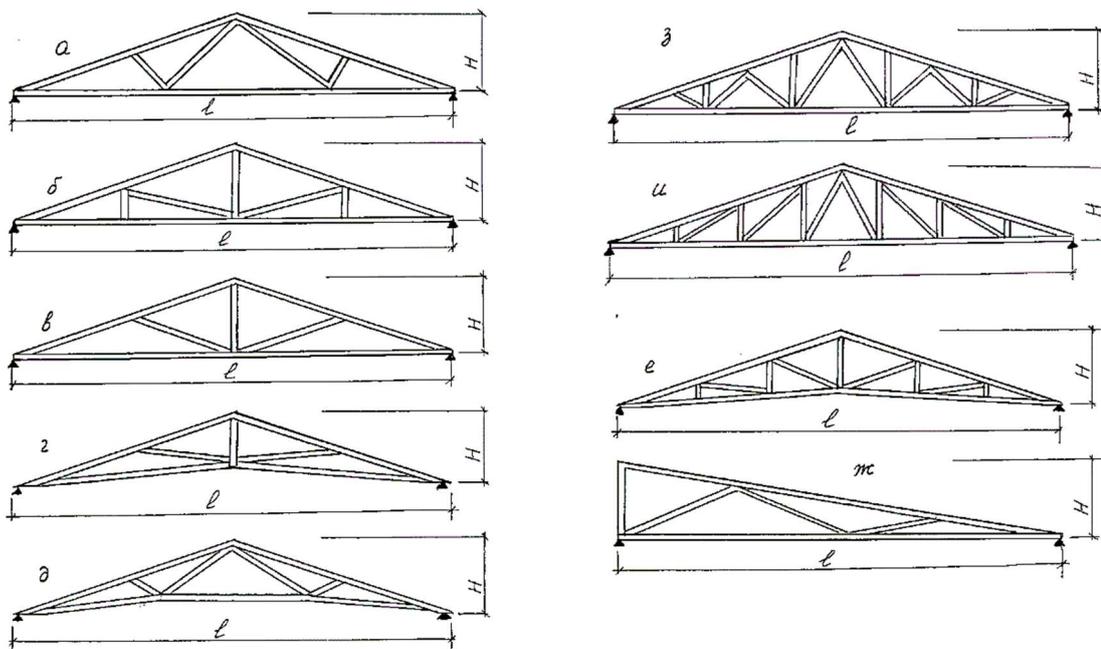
Основные типы деревянных ферм на металлических зубчатых пластинах:
